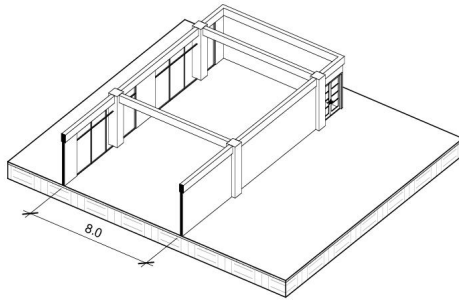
Sistema constructivo de marcos rígidos y cerramientos verticales y horizontales.
